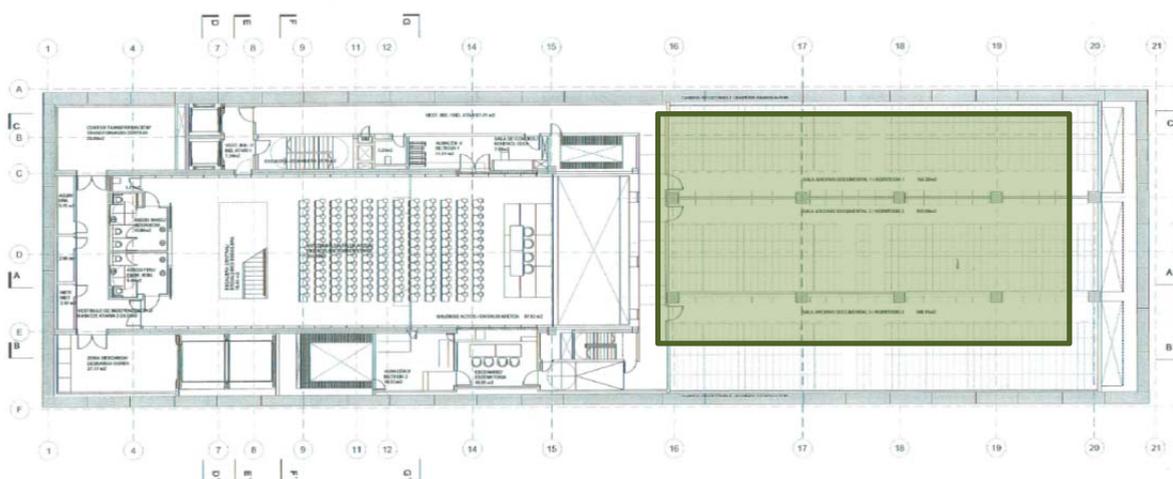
Planta sótano-1 del edificio, indicando ubicación prevista para el pabellón sobre el archivo.
